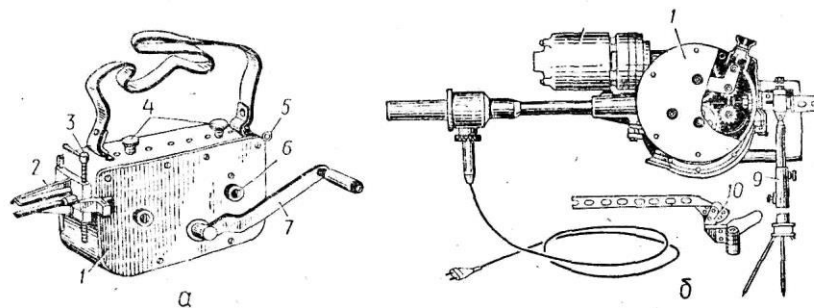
Борознофрези: а – горизонтальний; б – вертикальний; 1 – рукоятки; 2 – напрямний ролик; 3 – електродвигун; 4 – корпус; 5 – дискова фреза; 6 – пилозбирач; 7 – шланговий провід.
